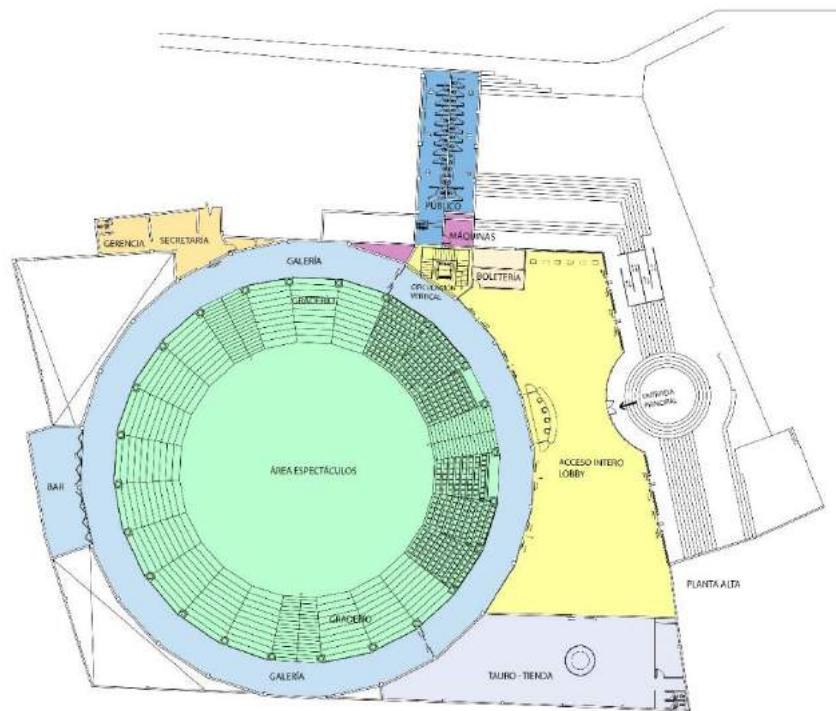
Zonificación planta alta, plaza de toros Belmonte
